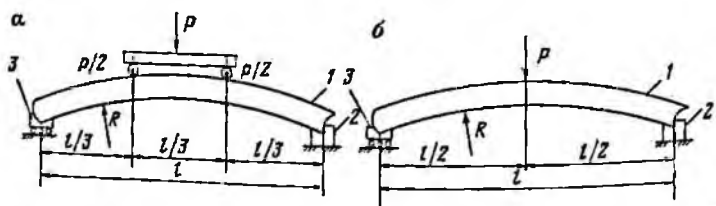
Схема испытания радиального железобетонного элемента сборной крепи:
